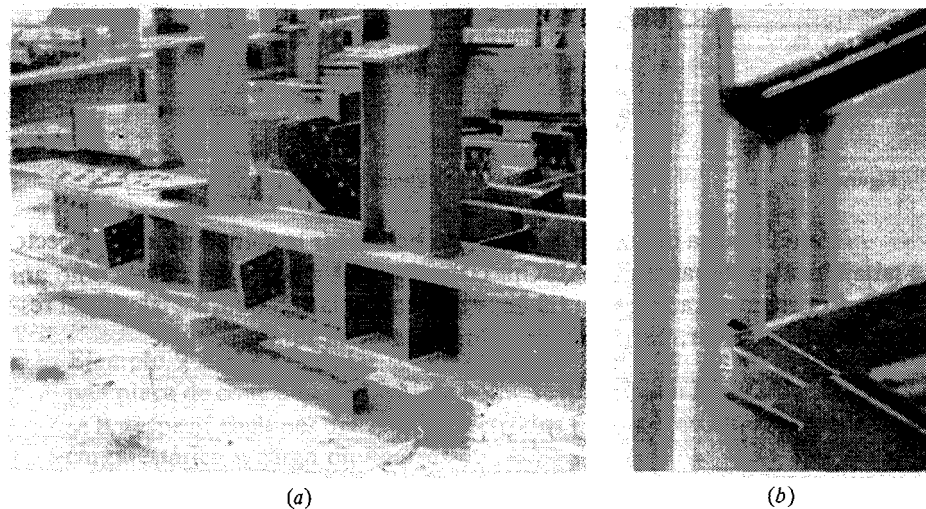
Conexiones rígidas de viga a columna. a) Vigas soldadas a tope con la columna. Nótese el uso de los atiesadores del alma de la columna opuestos a los patines de las vigas. La columna está en el patio de suministros, lista para su montaje. b) Conexión rígida usando un angular de asiento soldado por el tope (no se ve). Las soldaduras superiores para el elemento superior resistente a momento, se pueden ver junto con las soldaduras que mantienen el angular de conexión a la columna para tomar el cortante.
